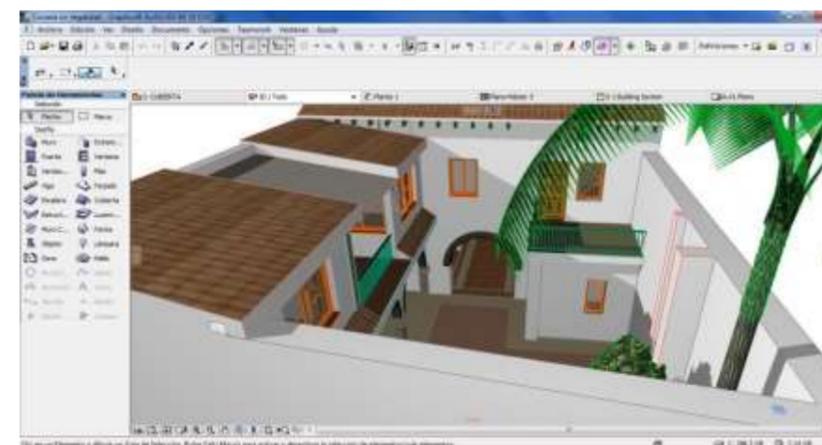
Captura trabajando el levantamiento en ArchiCAD
